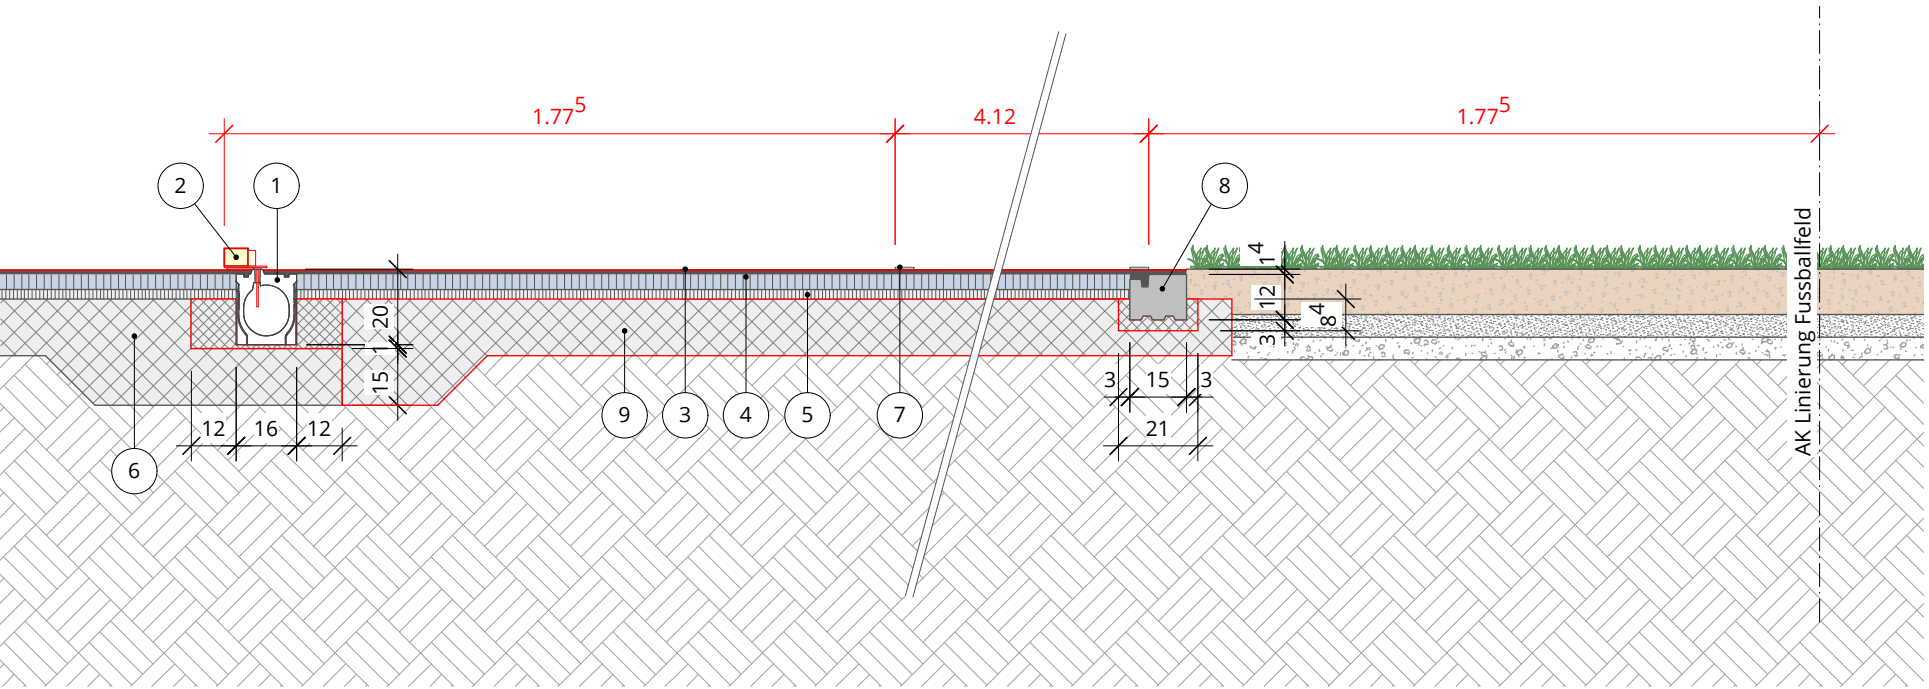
DETAILPLAN / SYSTEMSCHNITT S3-S3'
